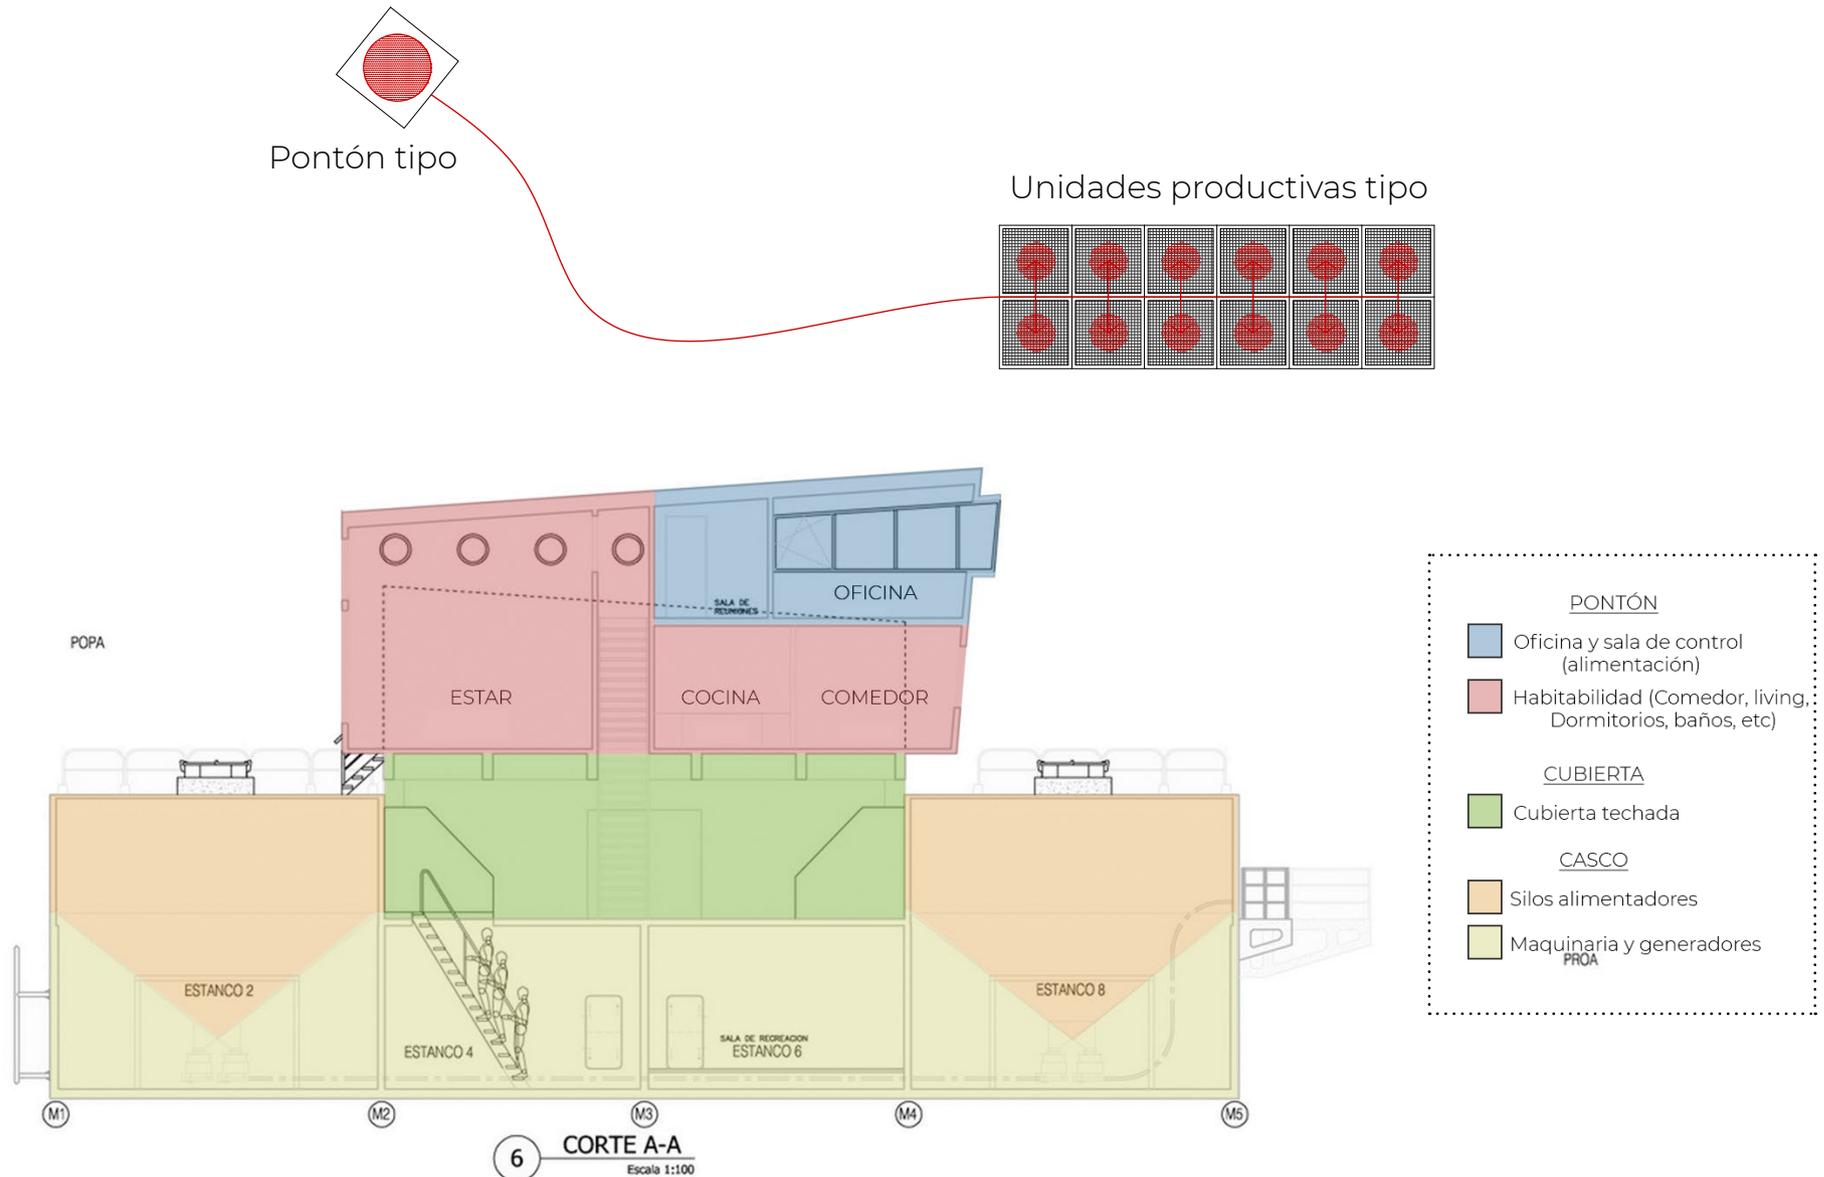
y 49: Elaboración propia / Distribución en planta y espacial de un pontón tipo.
